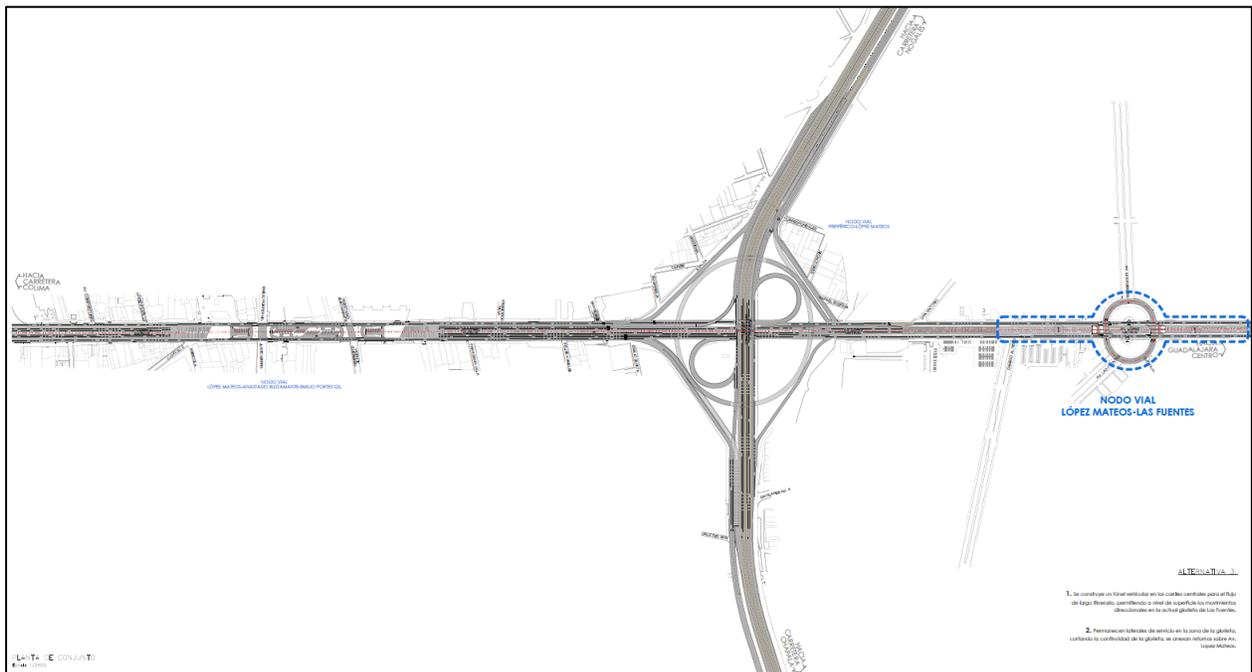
Planta de Conjunto del Proyecto, Nodo “Periférico – López Mateos”
